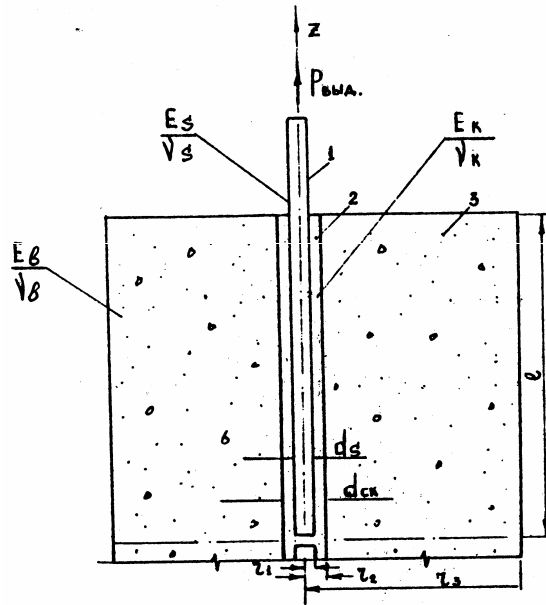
Расчетная схема анкерного соединения на акриловом клее:
